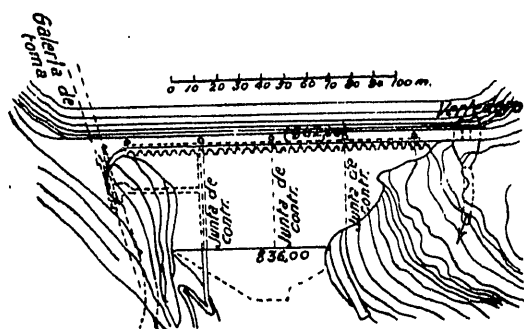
a Planta de la presa de Wägital y detalle de una junta de contracción
